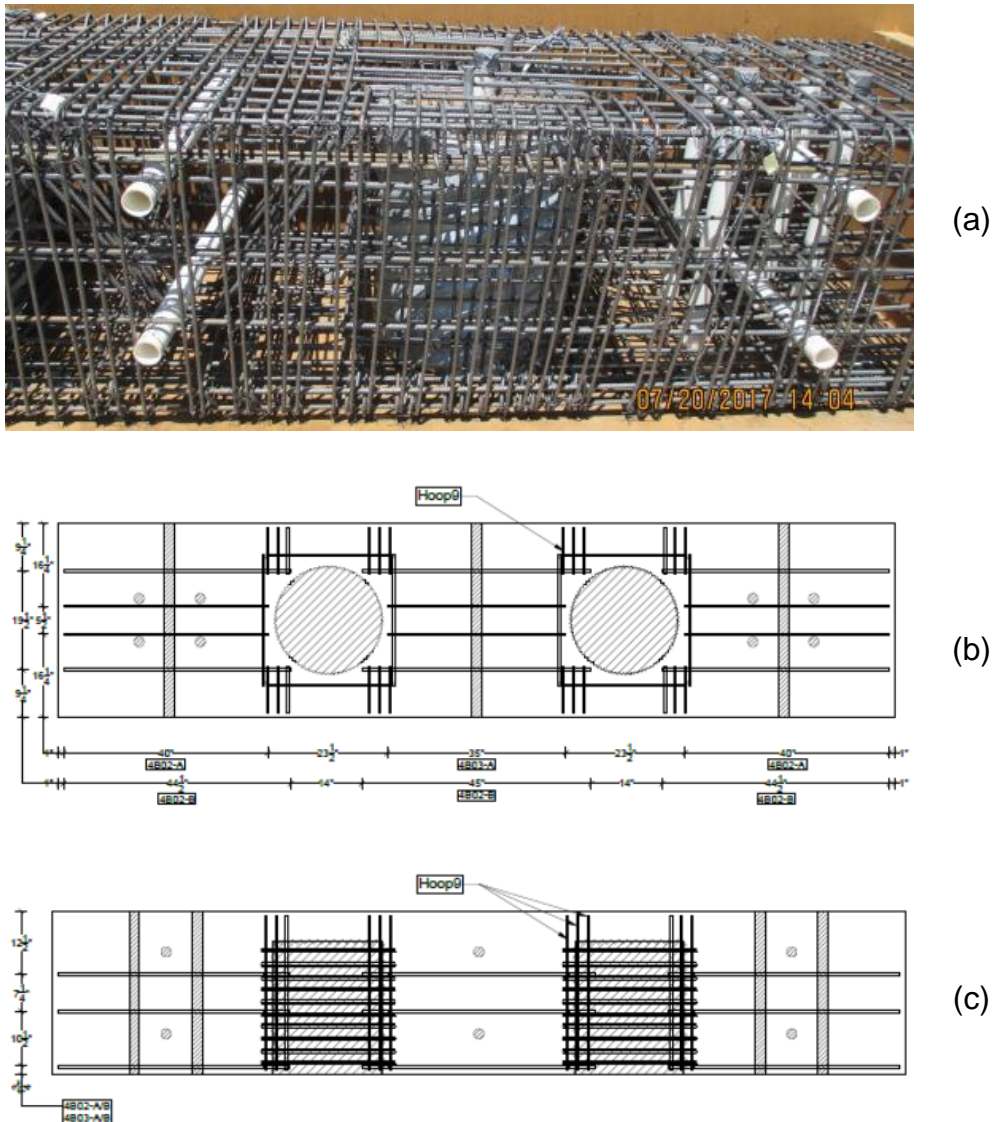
Particolare delle armature (a), sezione orizzontale (b) e sezione verticale della trave del blocco di carico (Blind prediction contest, 2017). / Longitudinal rebars (a) and horizontal (b) and vertical (c) sections of the cap beam (Blind prediction contest, 2017).
